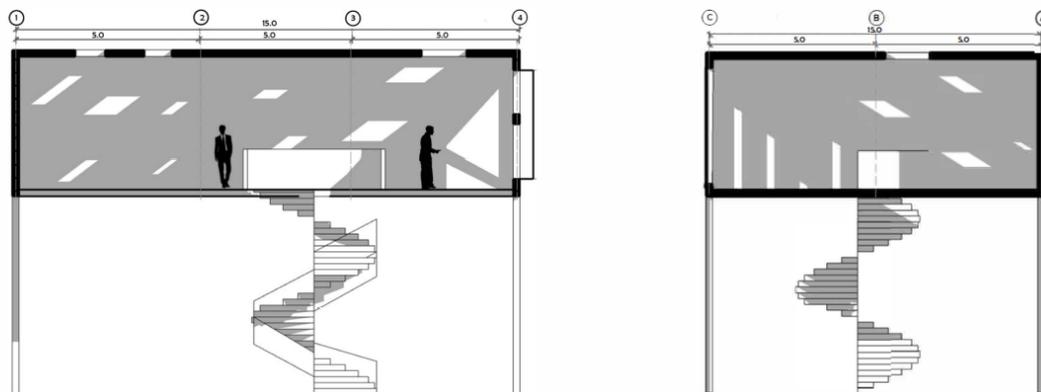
Planta Arquitectónica. (Imagen propia)
